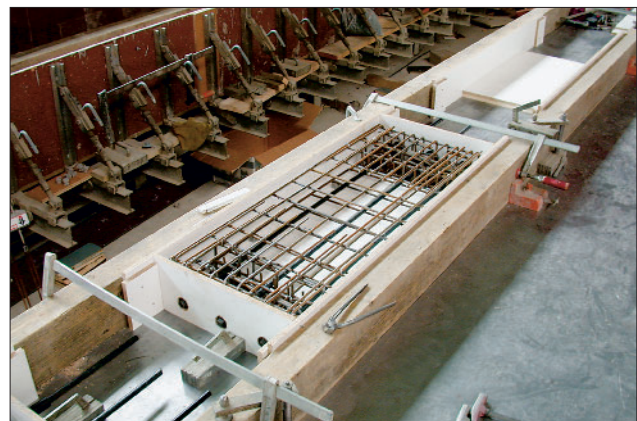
Verlegter Bewehrungsstahl im Versuchskörper der Begleitversuche
